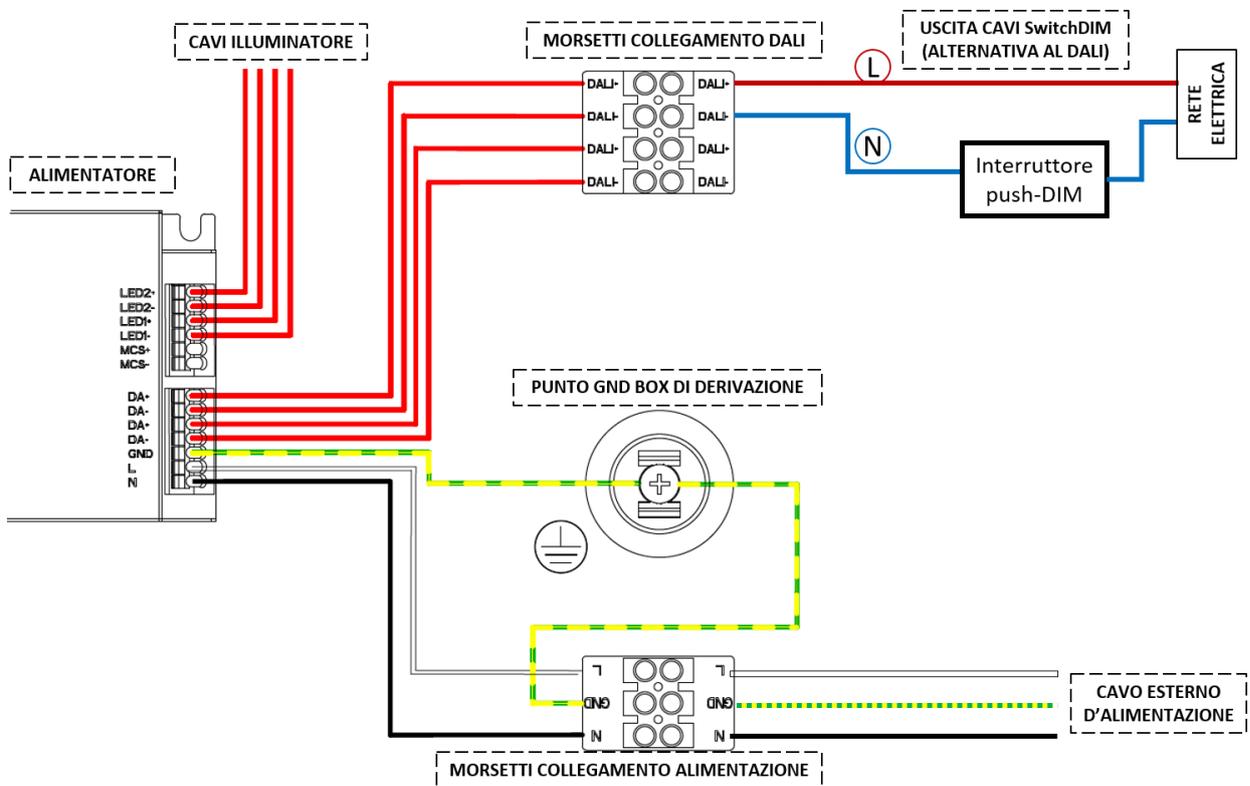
Schema dei collegamenti elettrici per il cablaggio esterno SwitchDIM.
